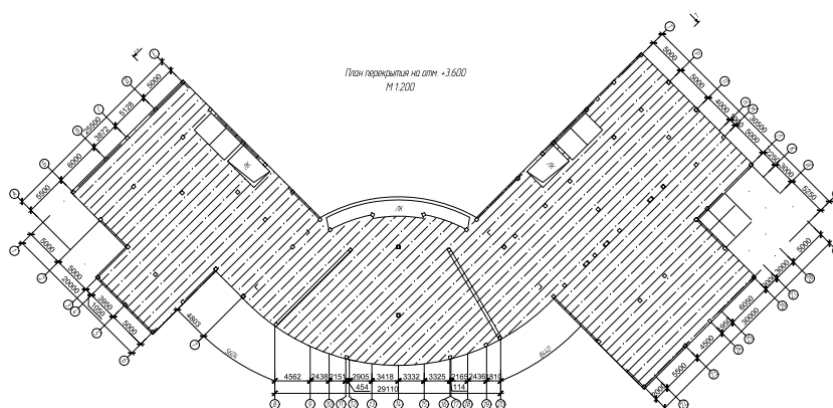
План перекрытия на отм. 3.600, М 1:200
